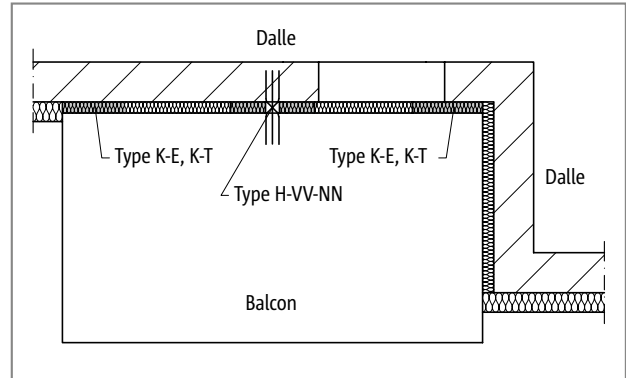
Schöck Isokorb® T Type H : Balcon en porte-à-faux
